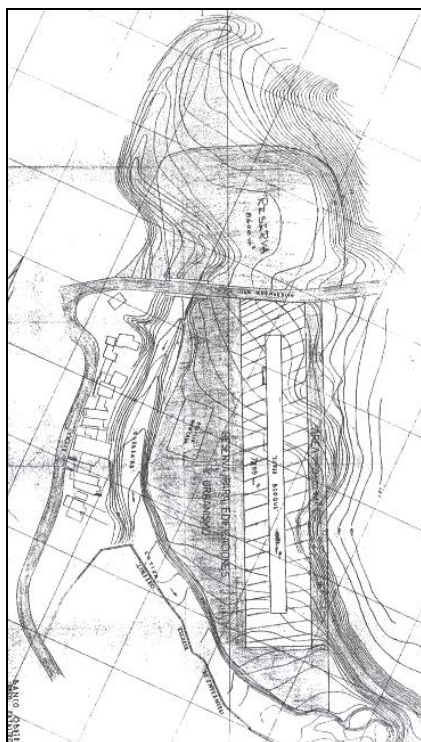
e. UV Cotiza. Plano de Conjunto. Obra ejecutada (1957)
